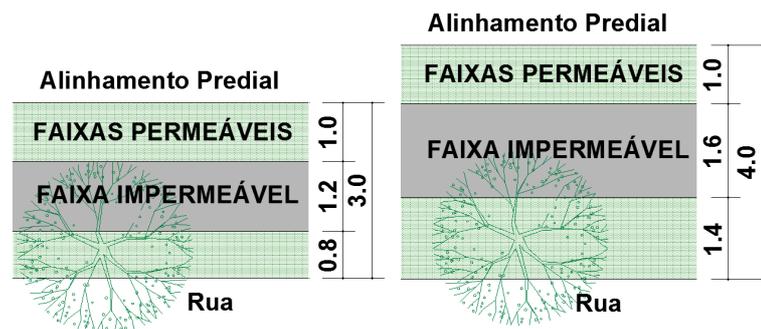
Esquema de implantação de faixas permeáveis em calçadas
